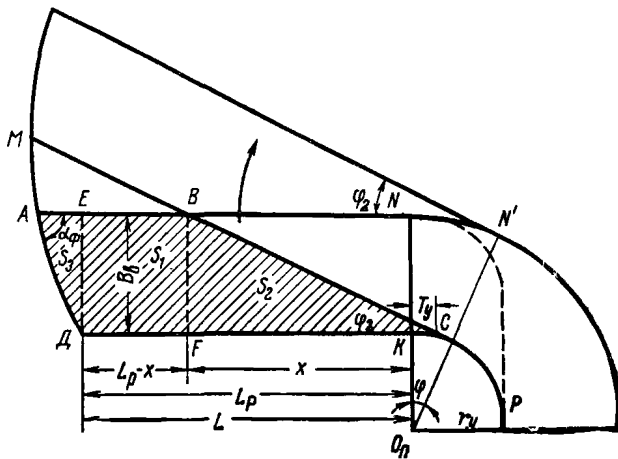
Расчетная схема для определения размера площадки зимнего вскрышного опережения при веерном перемещении фронта
